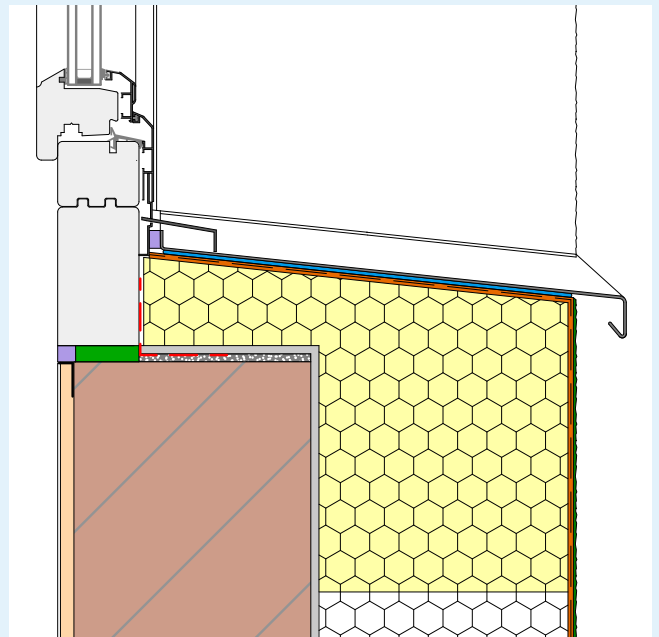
Auflegewinkel mit Gefälle als Auflager für Fensterbank
